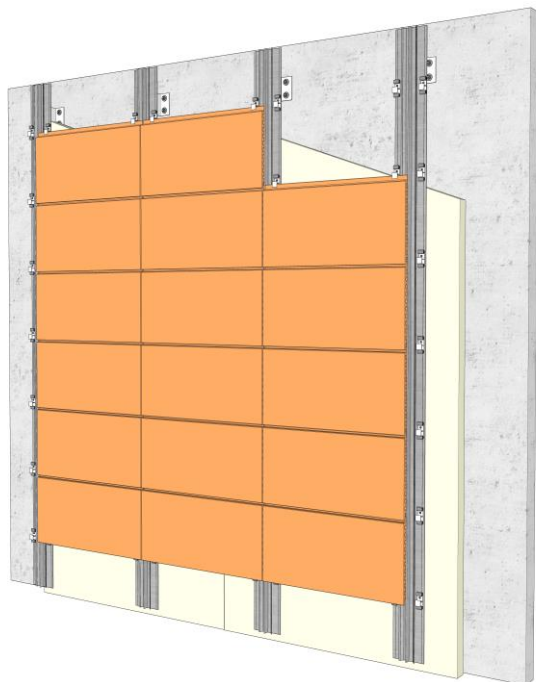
Kit Tempio® FK. Arranque de fachada.
